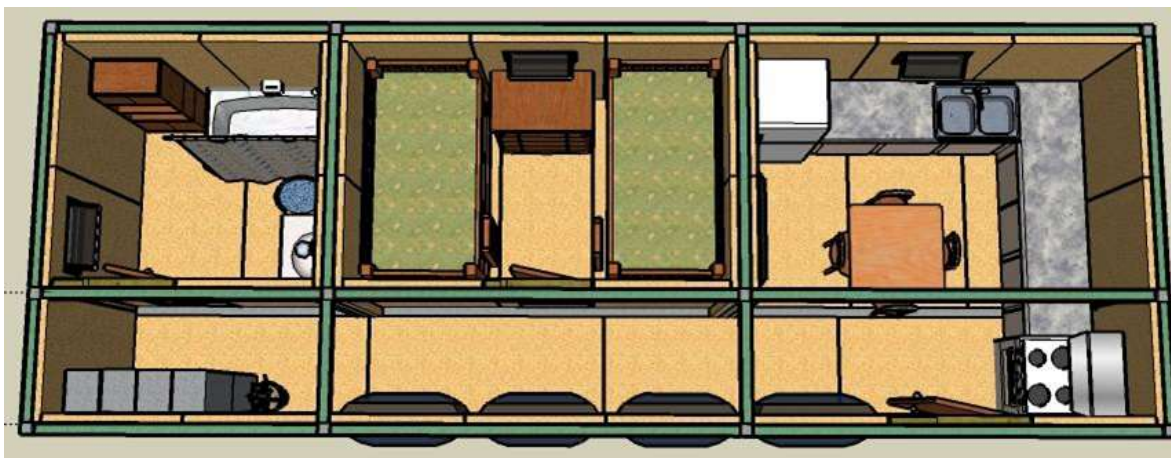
Vista de diseño de módulo piloto para la pequeña minería.
